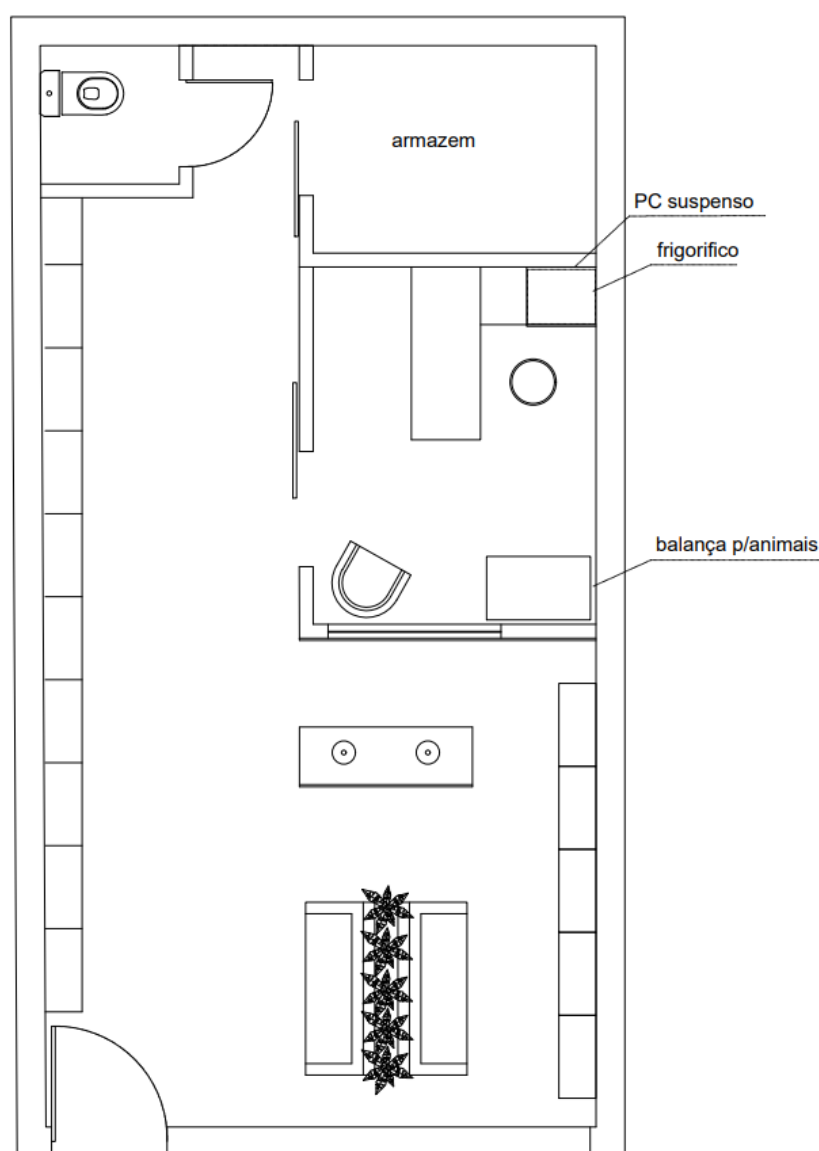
Planta de proposta para o espaço. Fonte: autor
